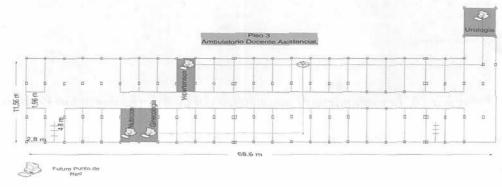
Levantamiento Planimétrico del piso 3. (Elaboración Propia)
